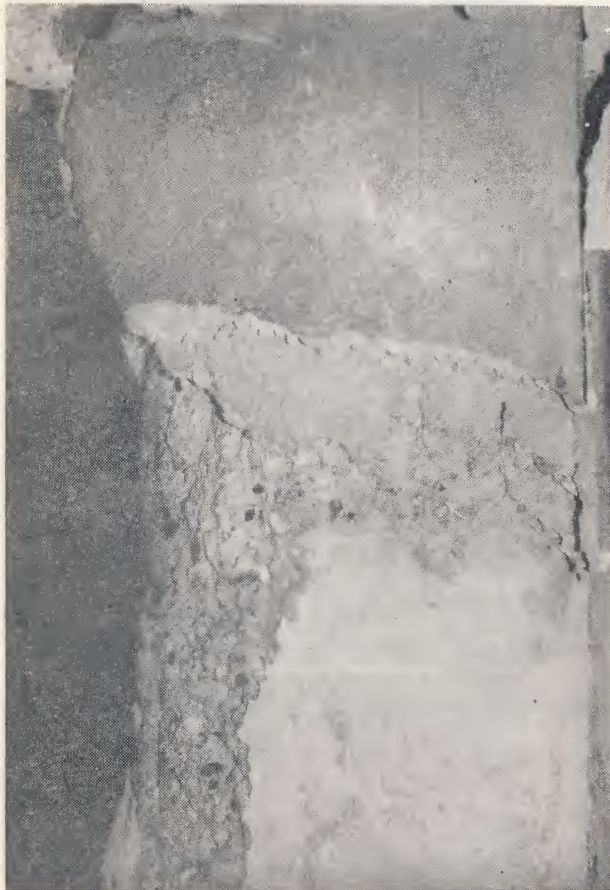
Oštećenje betonske jezgre nebodera između otvora za vrata
